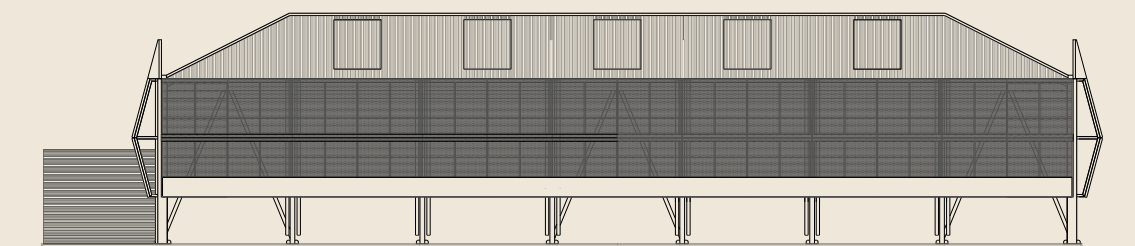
Vista de las graderías, Multicancha O'Higgins, Puerto Williams.
